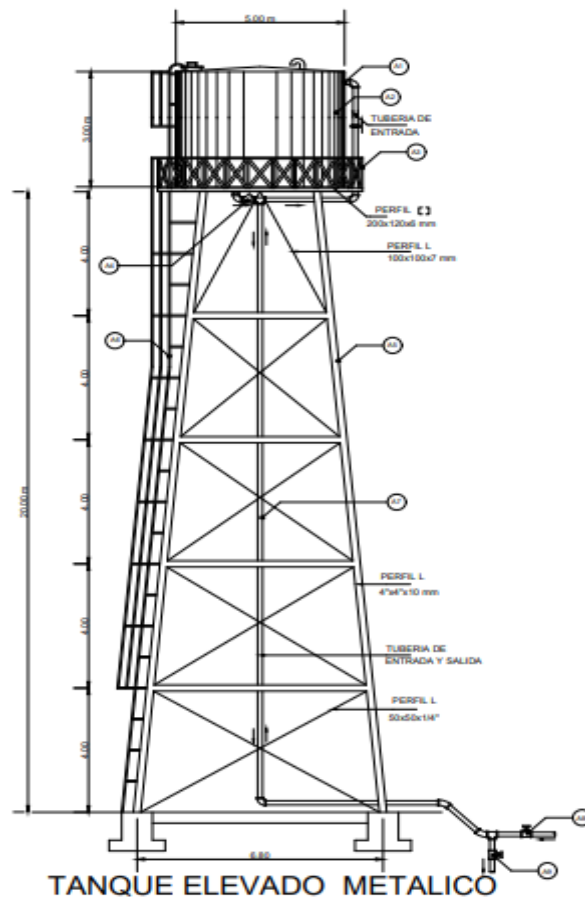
Diseño del tanque elevado metálico. Fuente: (PRAGUAS, 2011)
